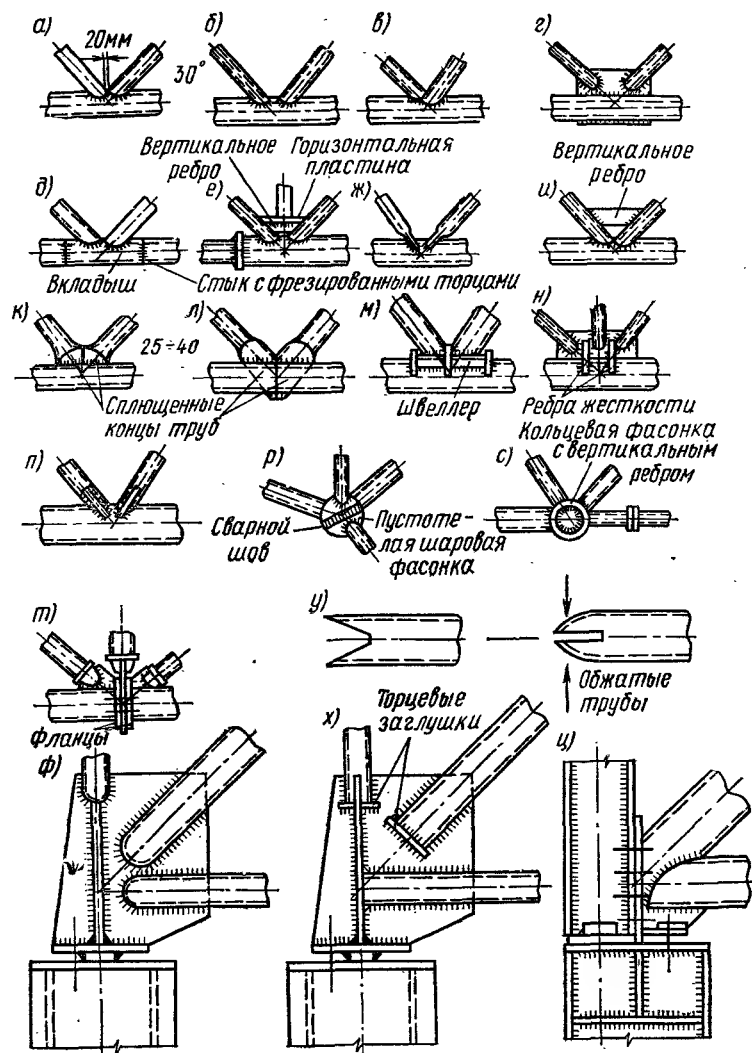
Узлы решетчатых конструкций со стержнями из круглых труб (а—и)
